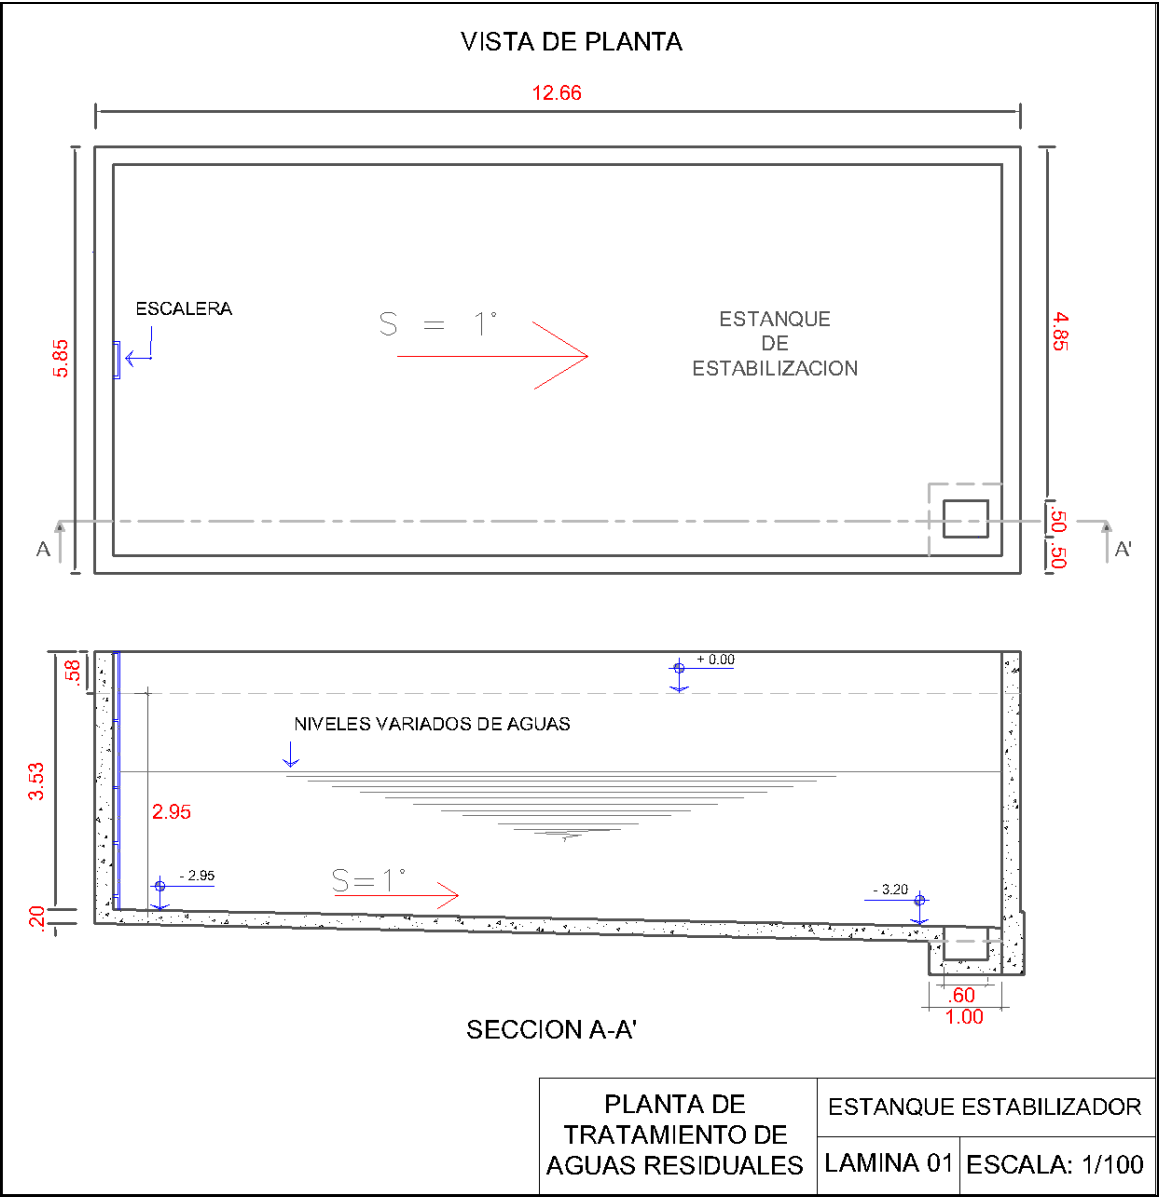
Vista de planta y sección A-A' del estanque de estabilización.
